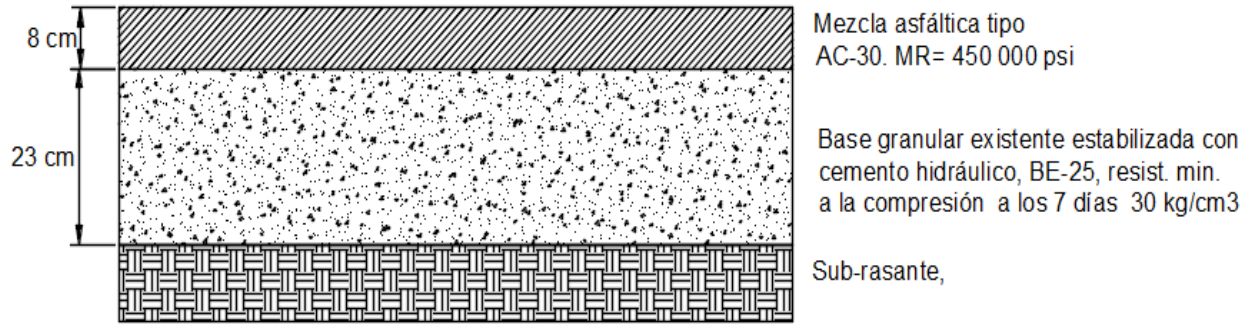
Perfil de la estructura de pavimento propuesta para el TH=1, P#4.
